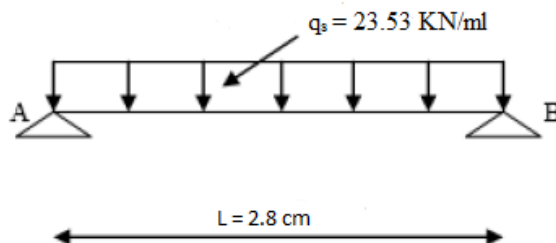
Schéma statique de la poutre palière a l'ELS.
